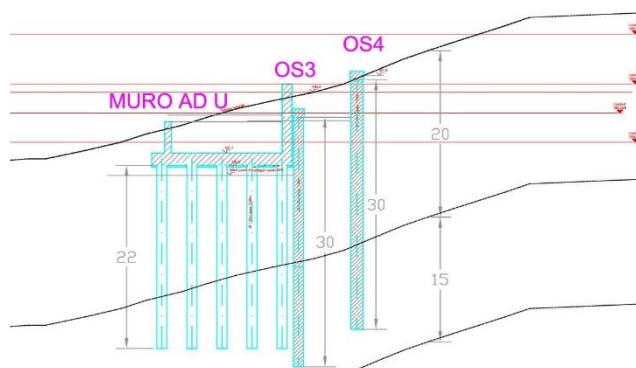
Geometria di riferimento OS-3 – OS-4 e Muro ad "U" (sezione 3-3).
